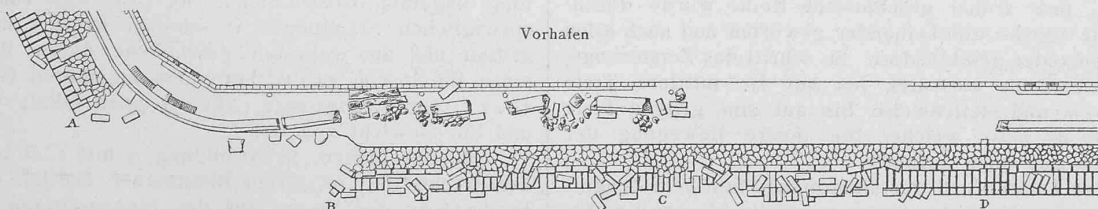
Lageplan des Molo Galliera an der Durchbruchstelle. — Masstab 1 : 2000.
